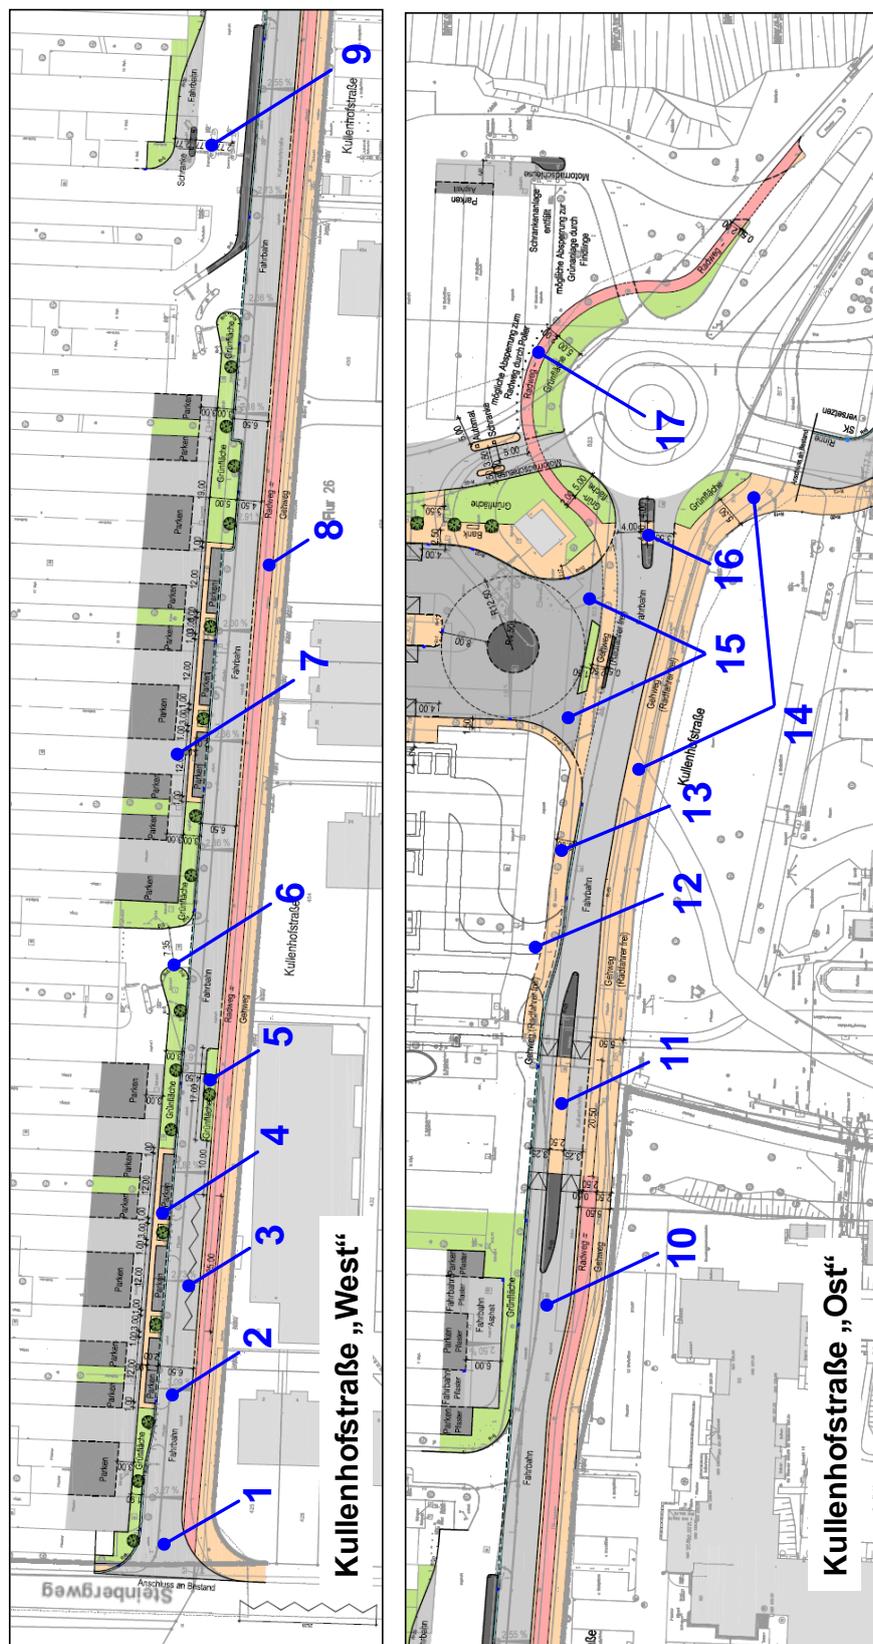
Vorplanung für den Umbau der Kullenhofstraße
